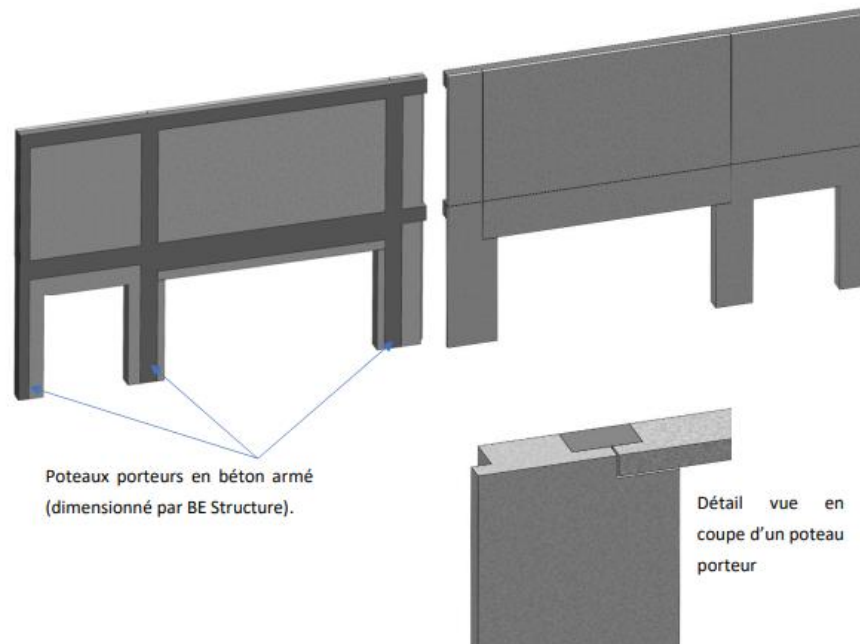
Principe des poteaux noyées dans les façades en béton de bois Extrait ATEx CS2.
